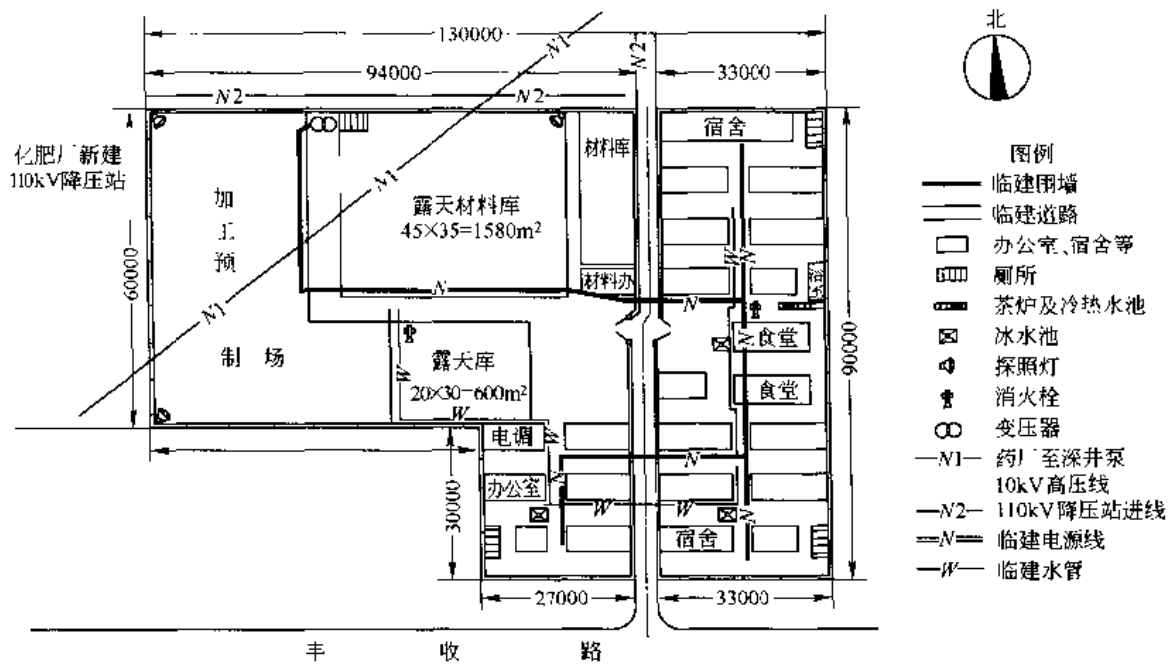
某化肥厂合成氨扩建工程施工临建平面布置图
